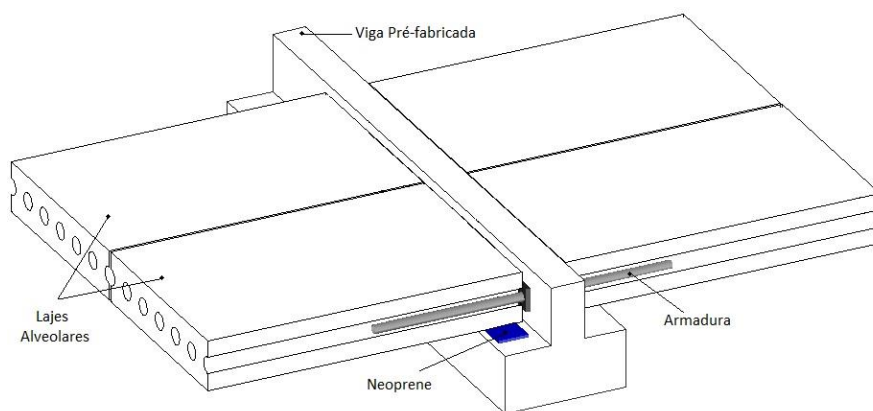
Ligação Laje – Viga central com amarração sem betonagem *in situ
